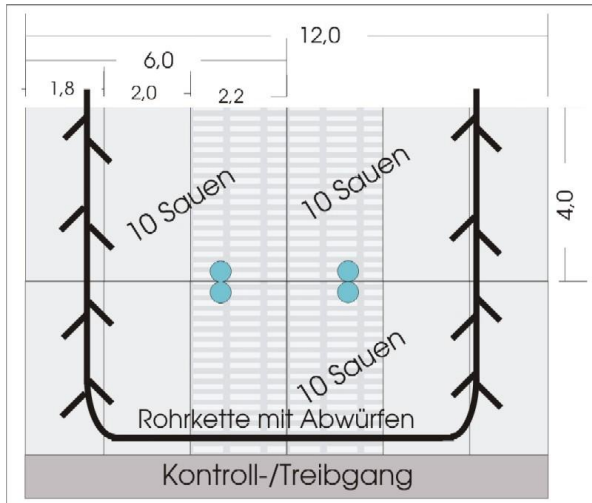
Grundriss von 4 Wartebuchten à 10 Sauen mit Bodenfütterung
